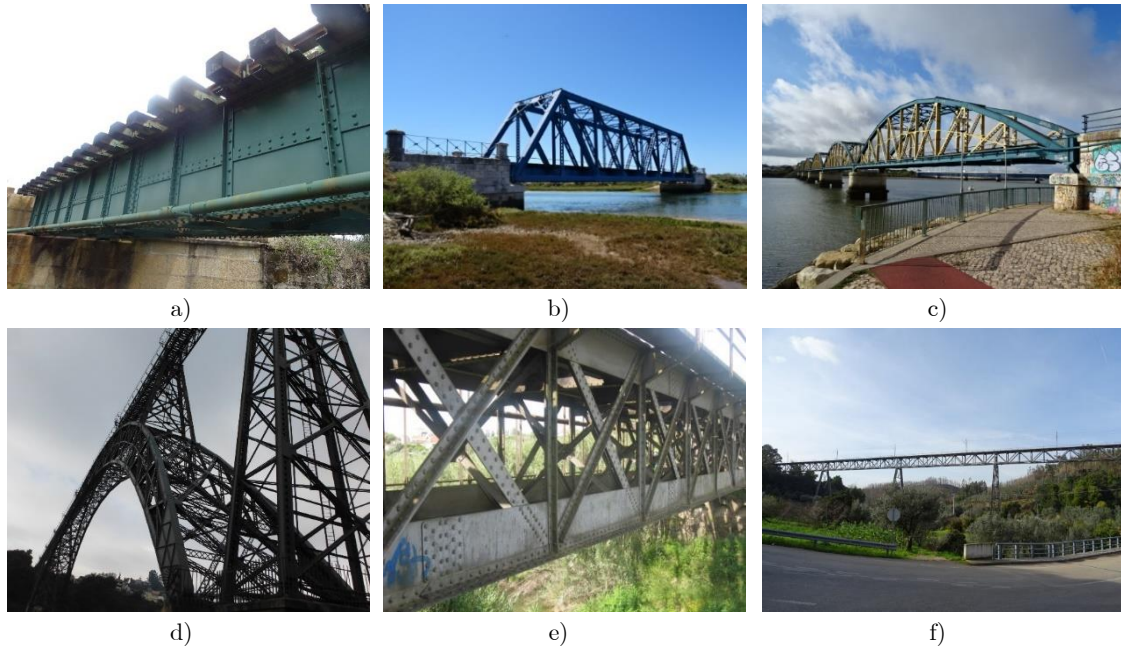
Estrutura de suporte ao tabuleiro: a) Viga de alma cheia, b) Viga Pratt (N) Reta, c) Viga Pratt (N) Parabólica, d) Viga em arco, e) Viga Cruz de Santo André e f) Viga Warren Reta.
